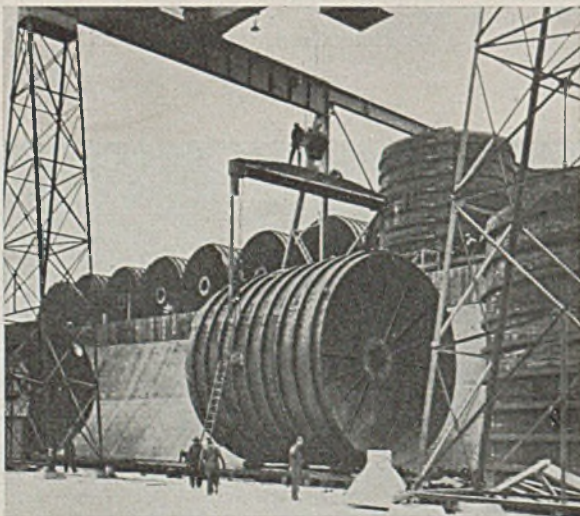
Absetzen eines Rohrschusses von 67 t Gewicht auf Spezialwagen. Rechts senkrechte Montage, im Hintergrund für den Transport fertig verspannte Rohrschüsse.
